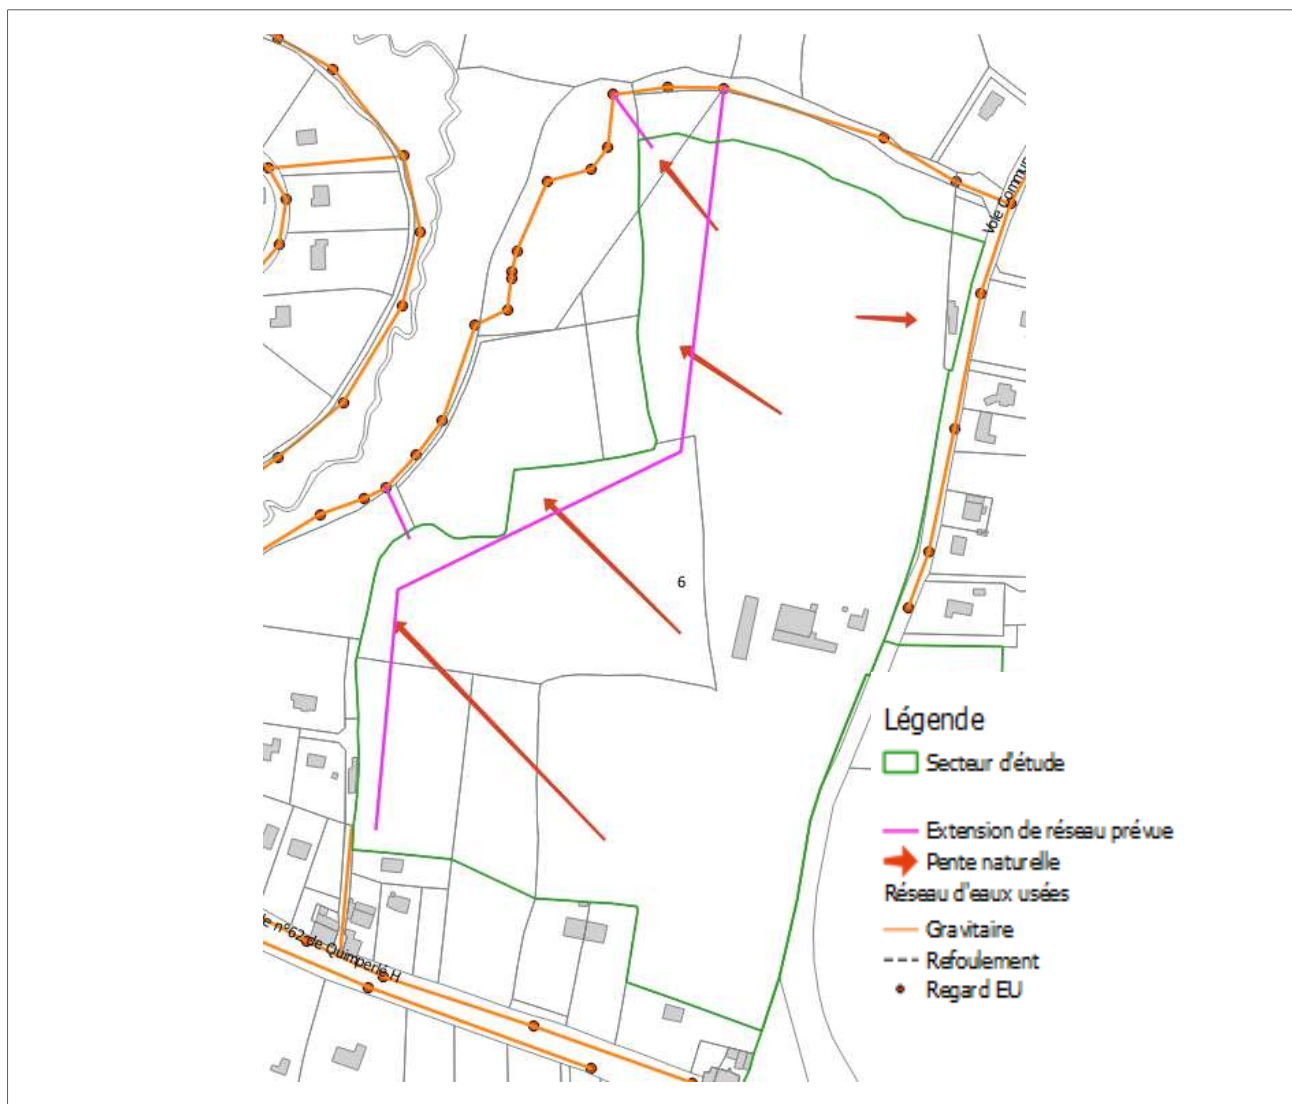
Localisation du secteur n°6 OAP 6 Sud rue du Croëziou
